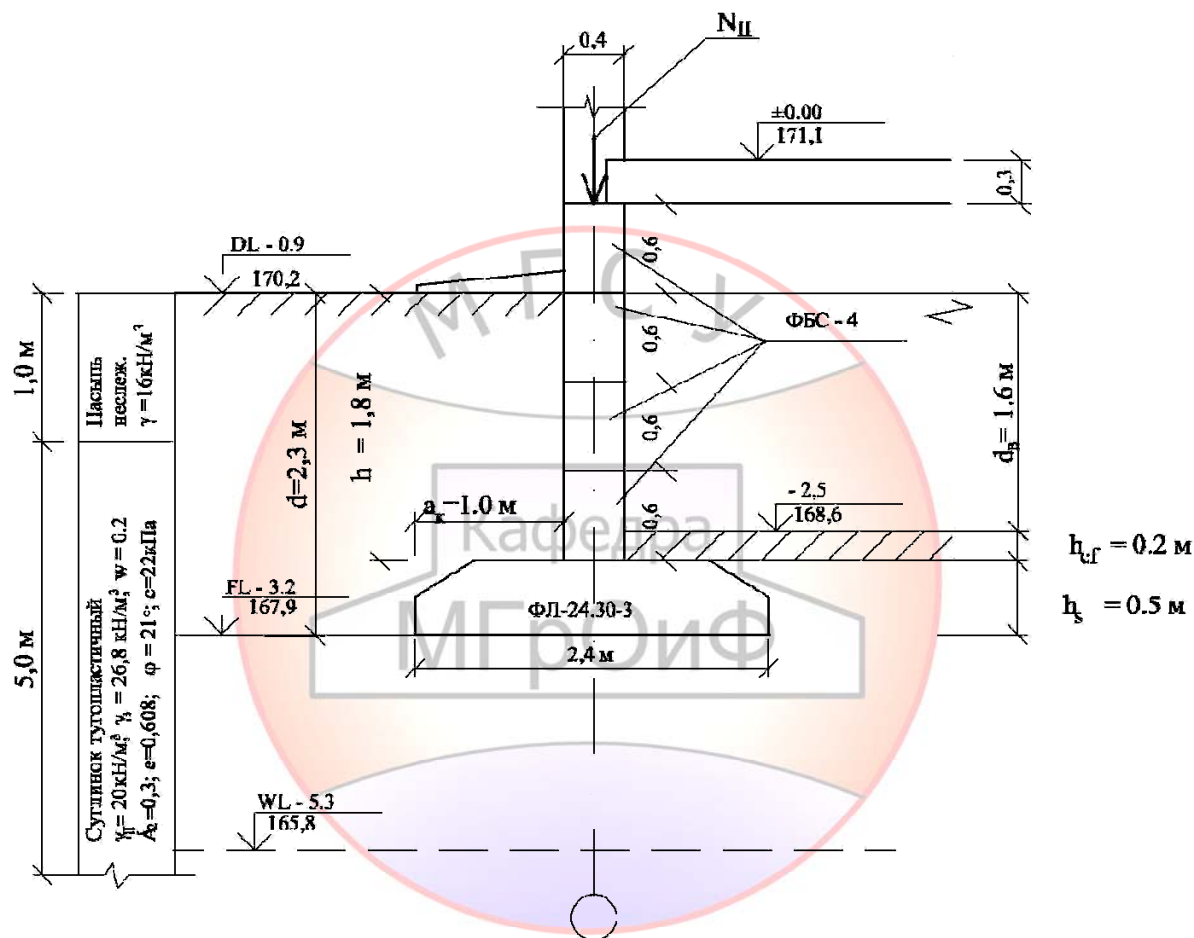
Схематический разрез фундамента под наружную стену.
